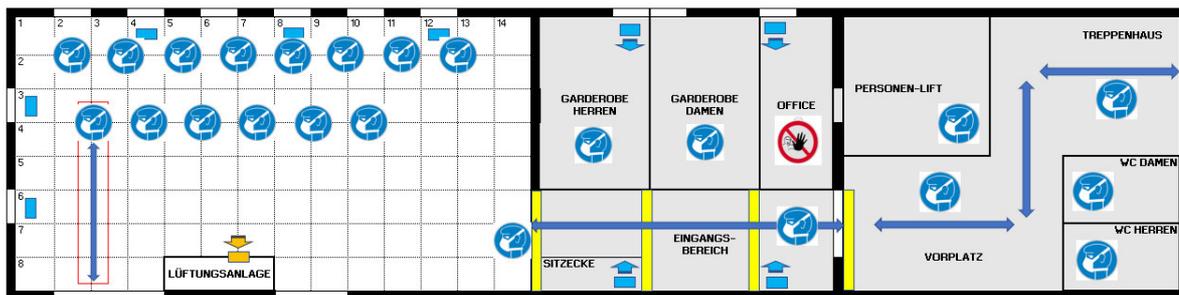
Gesamt-Grundriss Dojo Illnau
